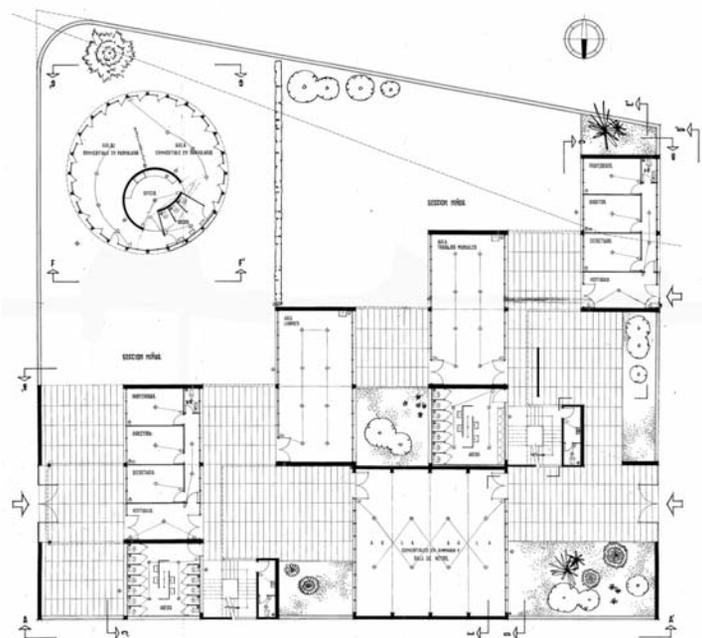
Pianta a quota + 0.00. (Foto tratta dall'archivio dello studio MBM, tav. RH-122 n. 2, Barcellona)
